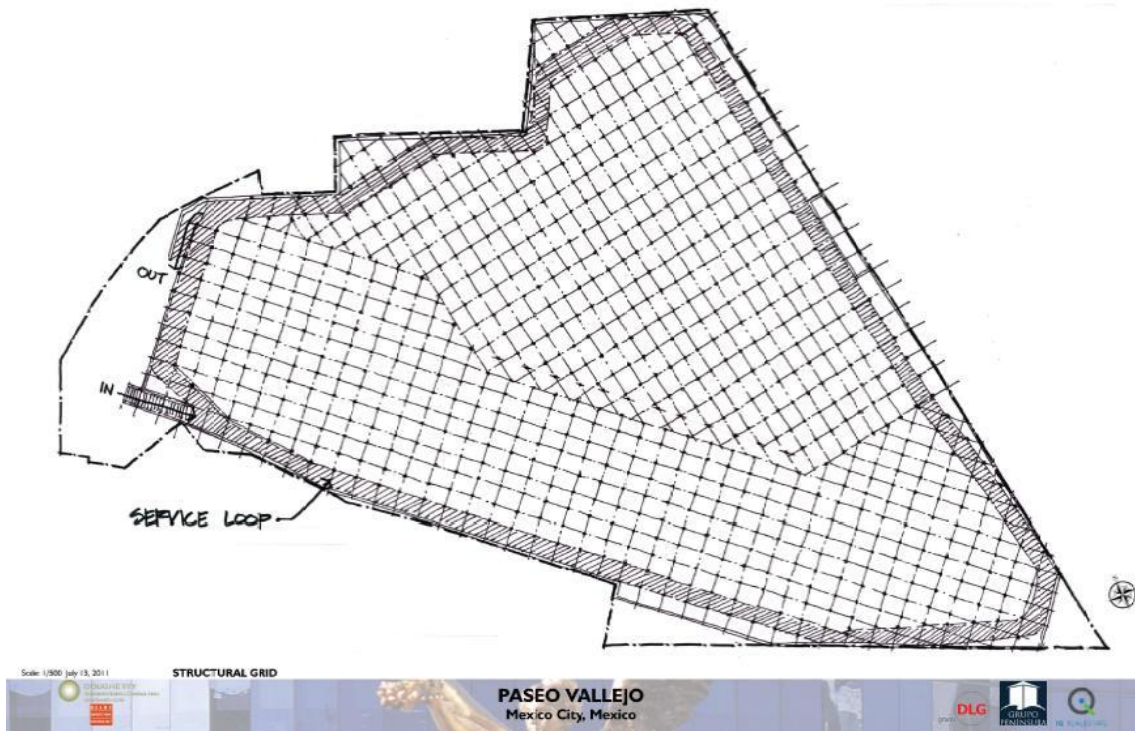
SEMBRADO DE LAS ESTRUCTURAS DE INTERES
